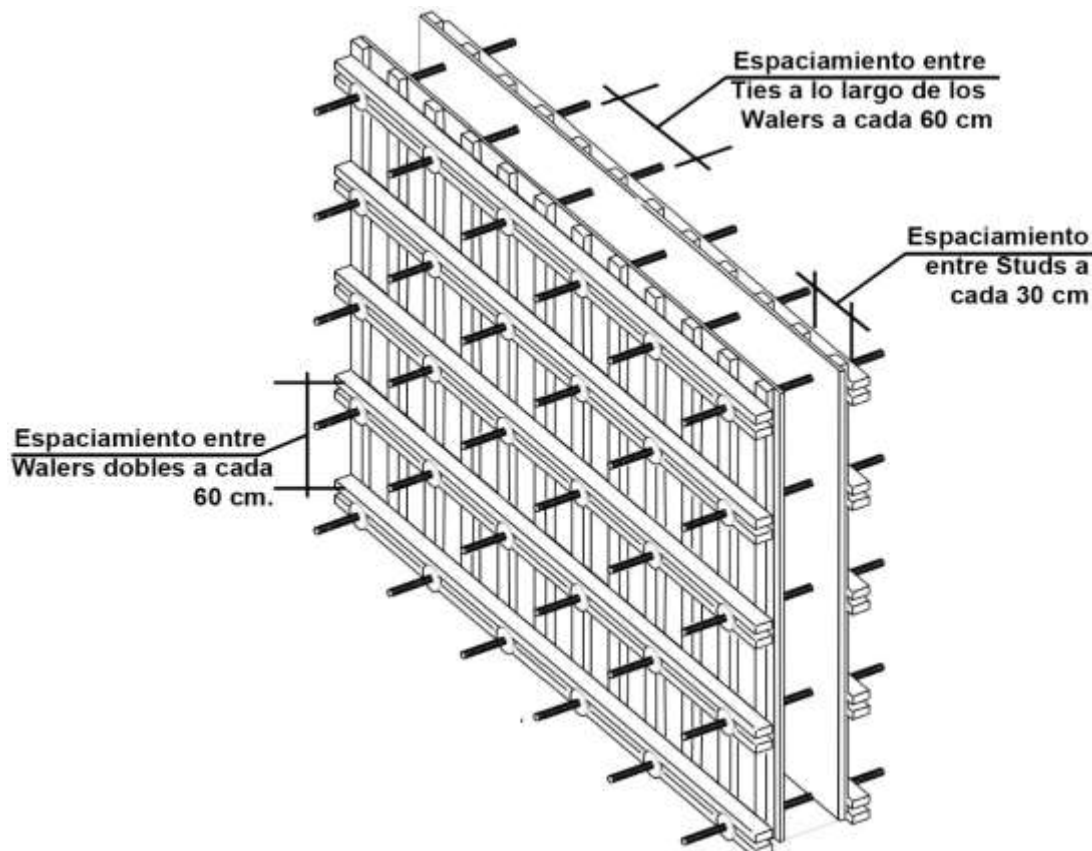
Distribución de studs, walers y Ties para el encofrado de muros dado. Reyes, (2020)
